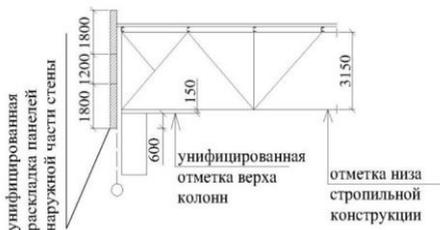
Схемы стальных стропильных и подстропильных ферм
